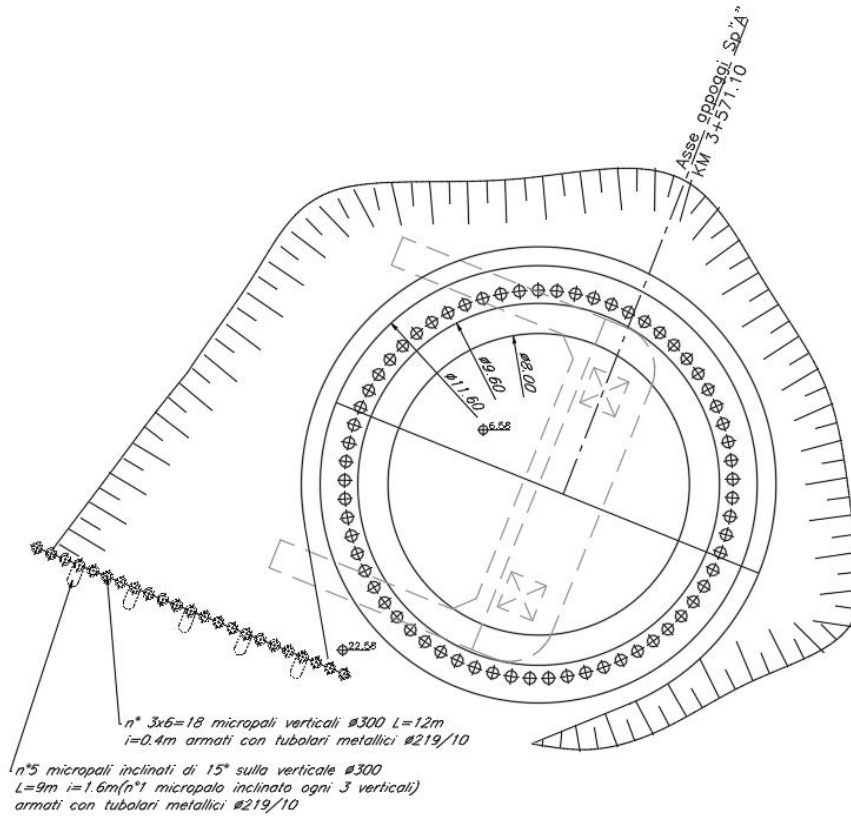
Pianta Opere Provvisionali Spalla A
